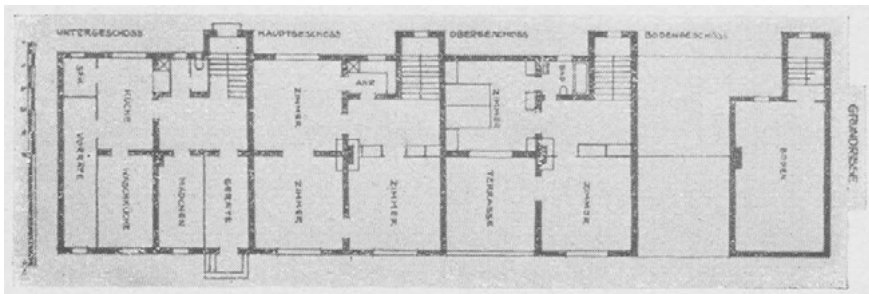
Grundrisse Reihenhäuser I. S. Abb. 10 u. 11
